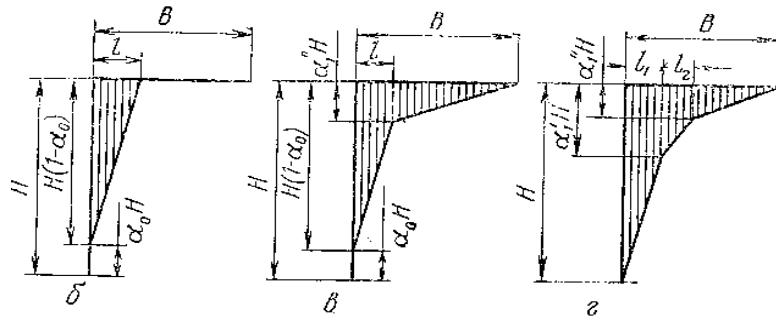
К расчету напряжений в бетонных гравитационных плотинах:
